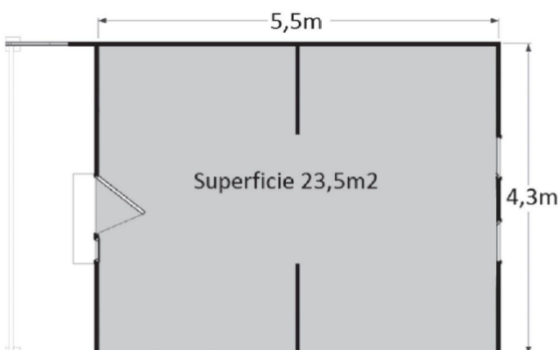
Planta unidad básica. Fuente: Garay, R et all. (2014).
